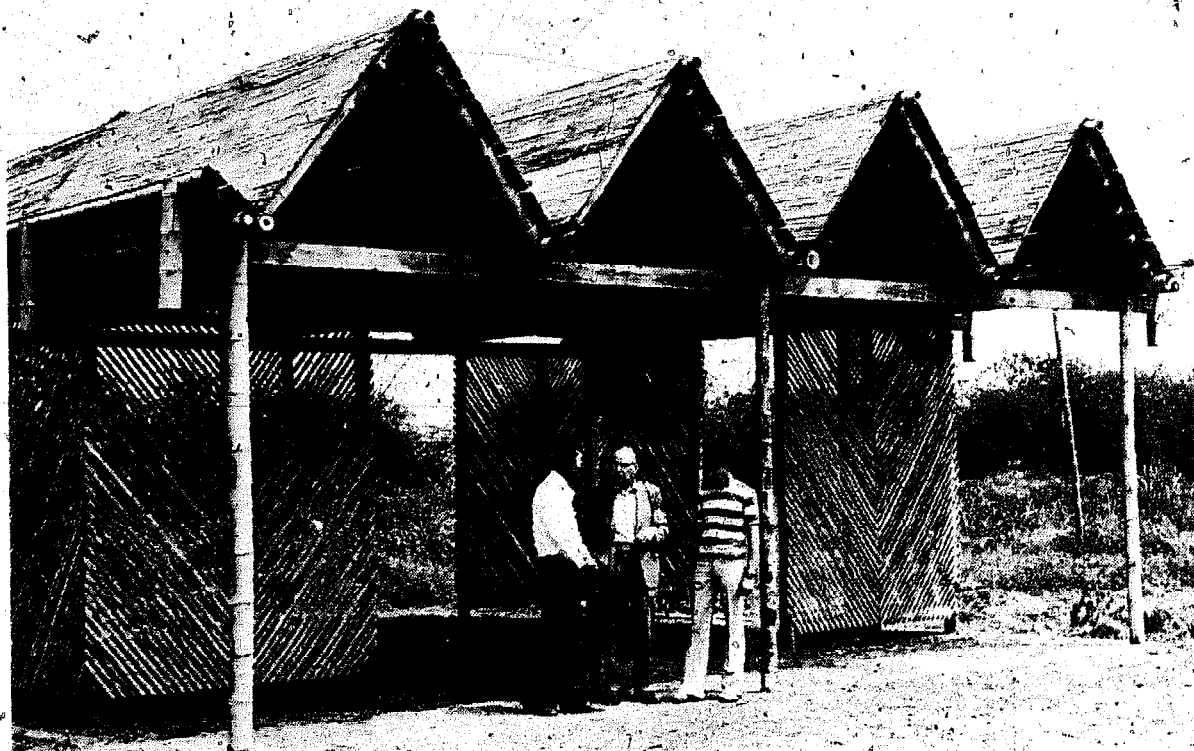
Vista exterior de la estructura de guadua una vez terminada y lista para la aplicación o colocación de la cubierta.
